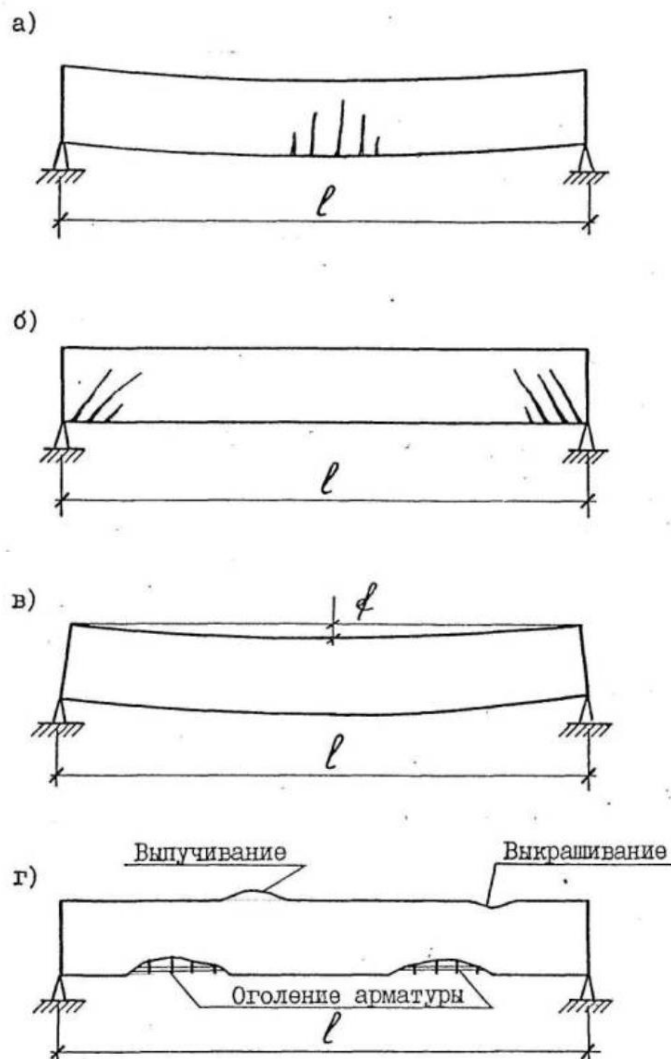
Дефекты железобетонных балок (плит)
